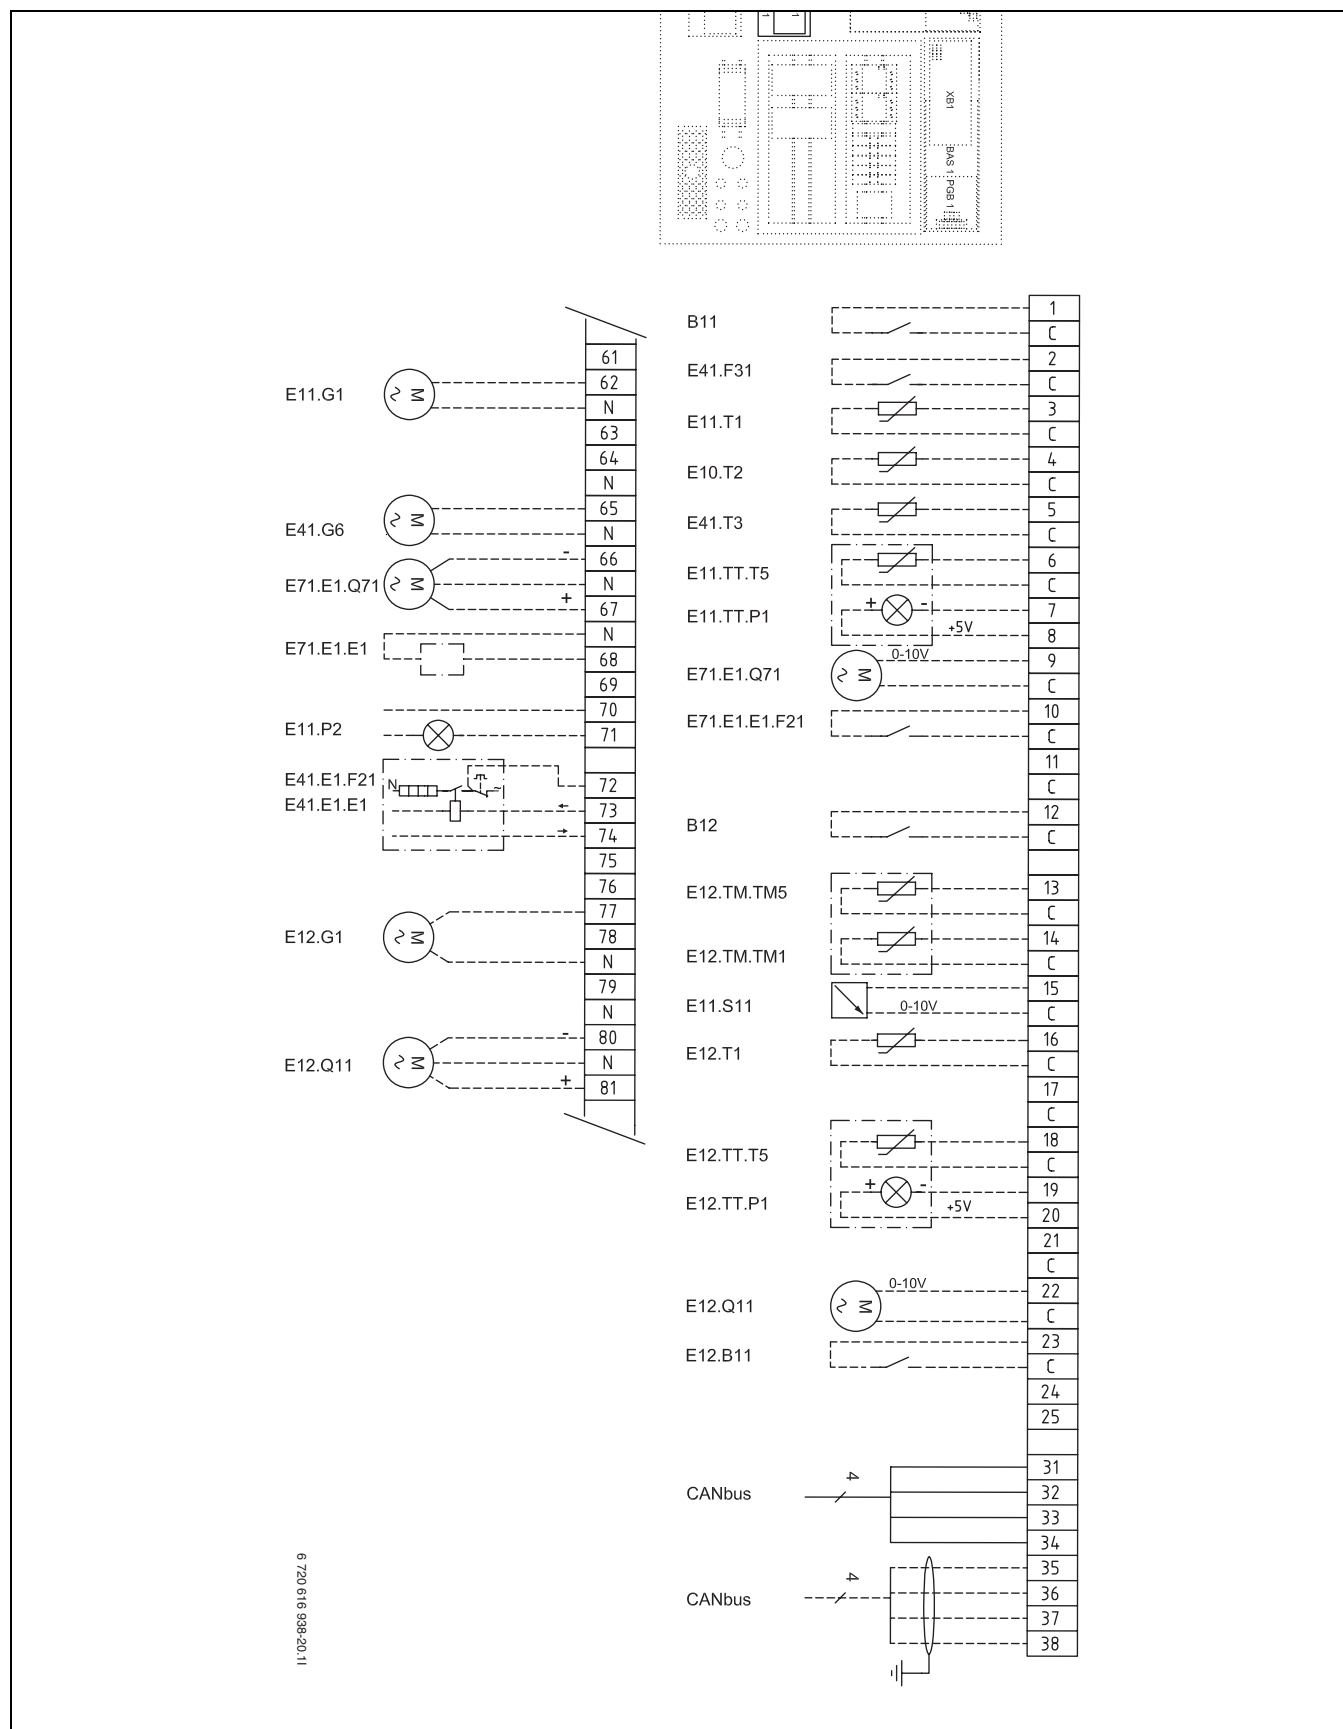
Externe Anschlüsse E21 (T 220-1 - T 600-1)
